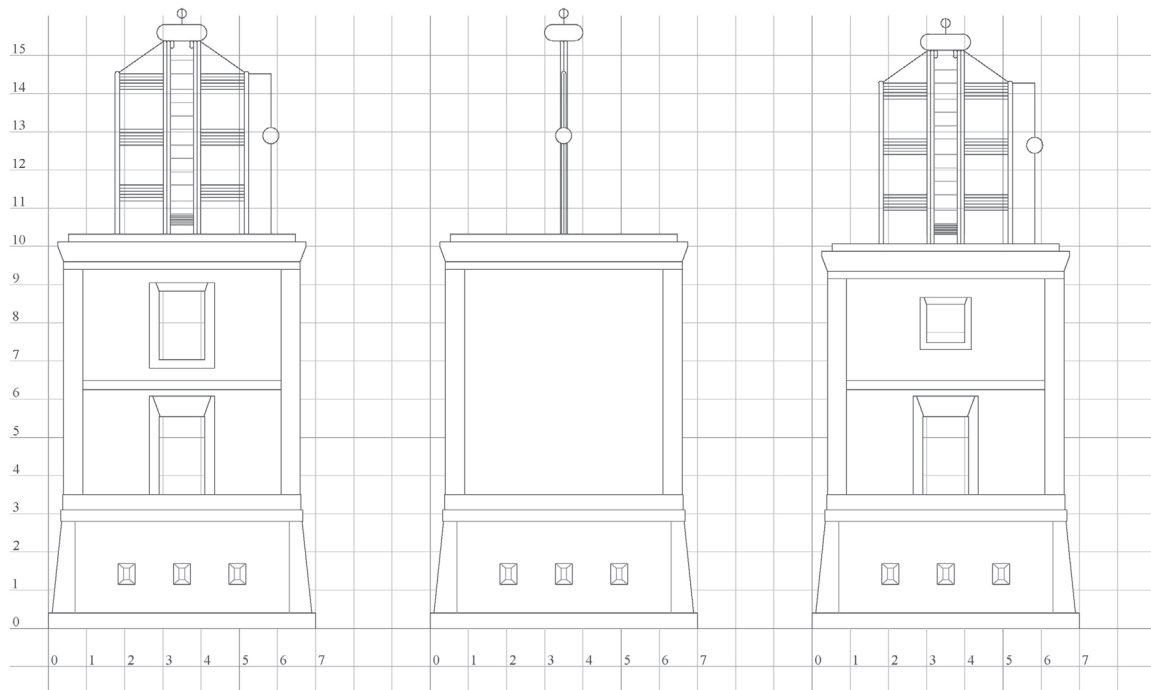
Fachada tipo de la torre del telégrafo óptico. De izquierda a derecha, fachada de 1844 con huecos iguales en todas las plantas, fachada de la variante maciza y fachada con huecos desiguales de 1848.
